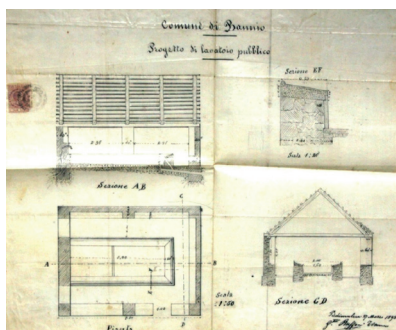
Elaborati del progetto di restauro e risanamento conservativo del lavatoio di Santa Maria Maggiore.
